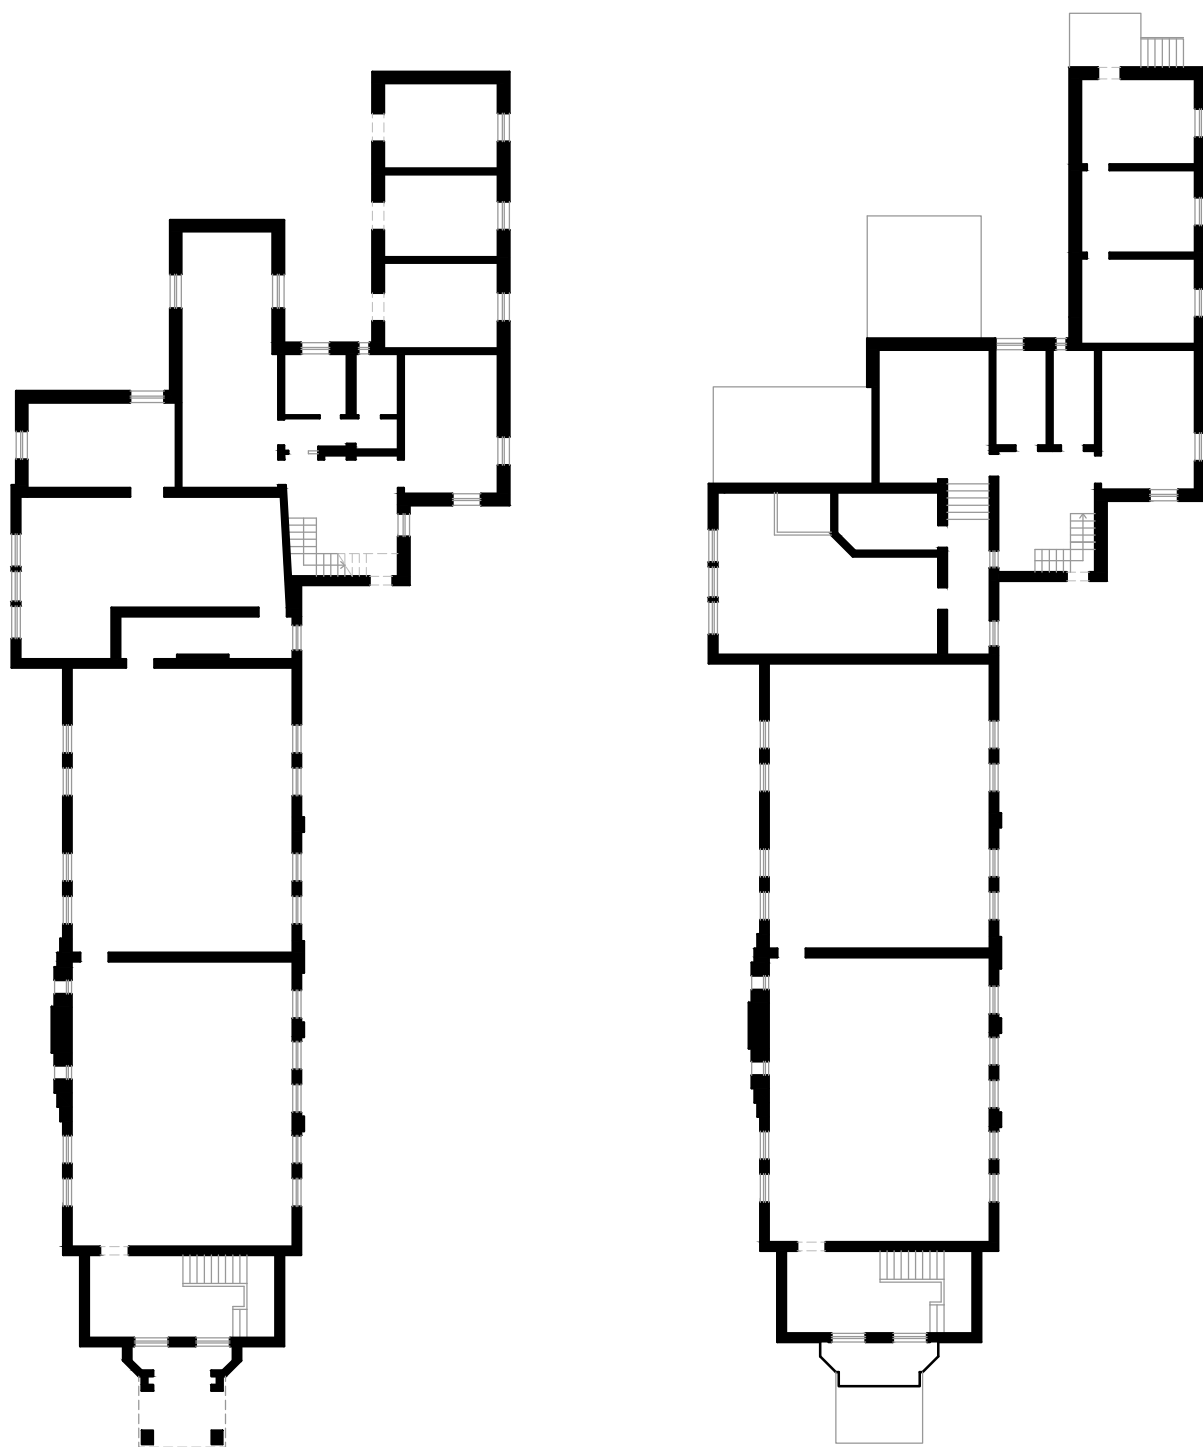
Assembly Hall*, Planta alta y planta baja
